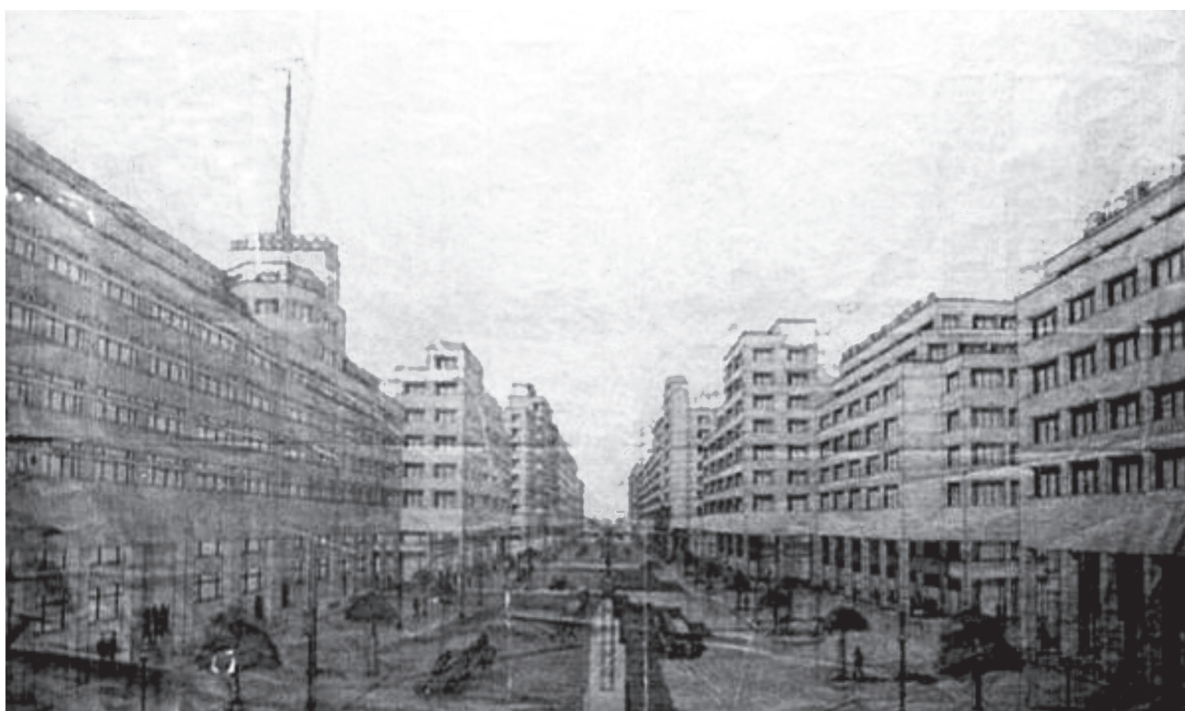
Plano da CPC para a Avenida 10 de Novembro (atual Guararapes).
